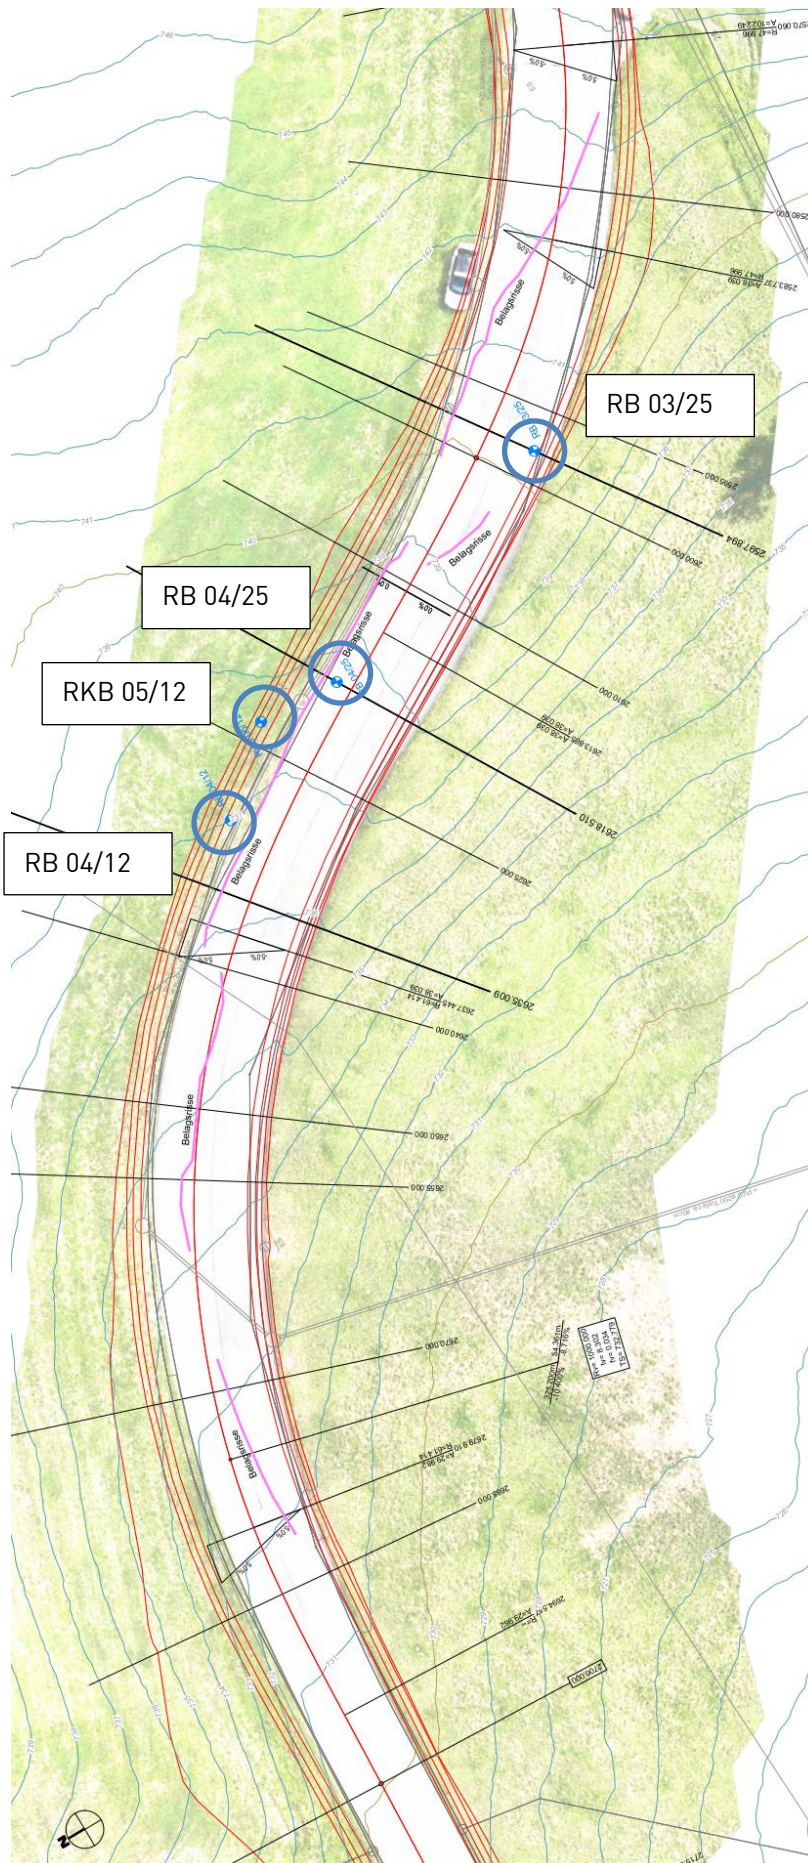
Situationsplan mit Lage der Sondierungen und der Belagsrisse.
